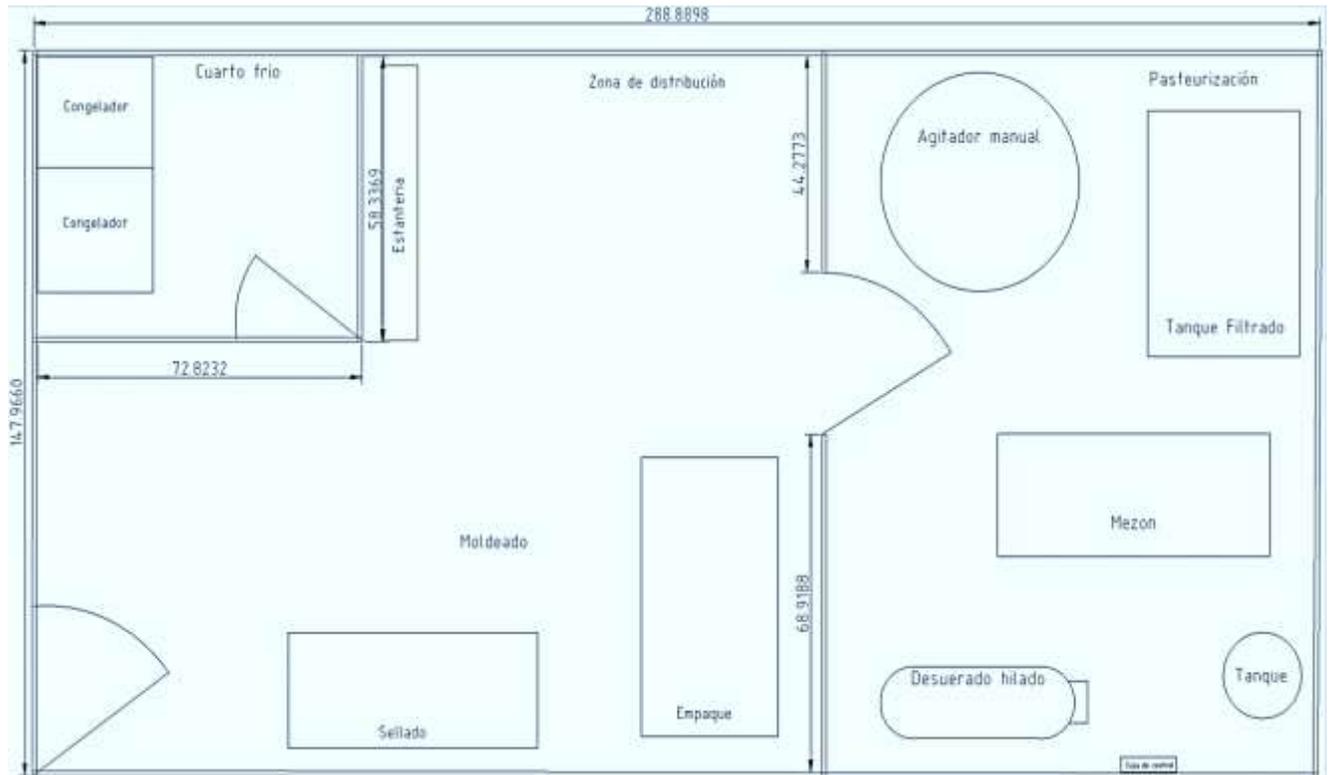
Fuente elaboración propia planos de planta quesos oro blanco
